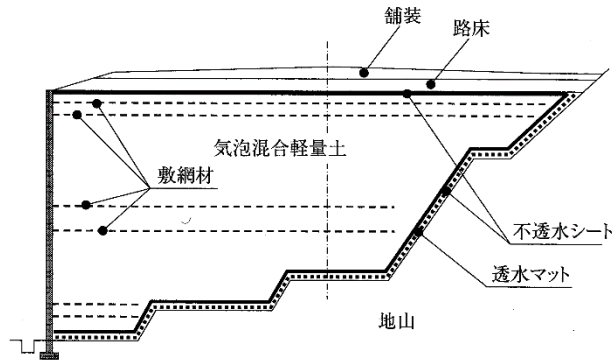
不透水シート、敷網材の施工例⁸⁾
